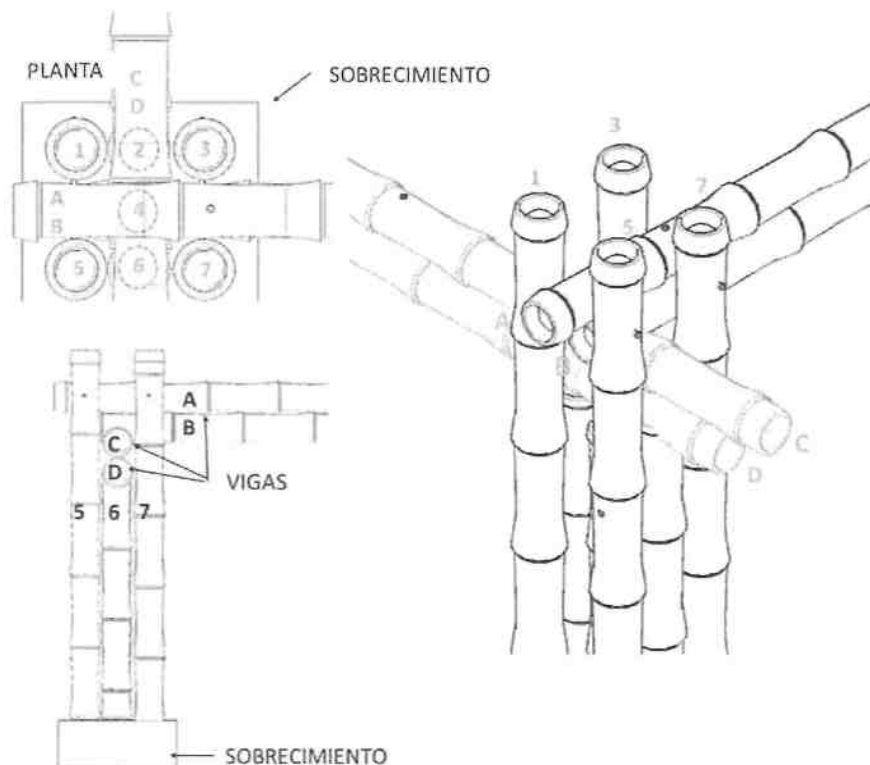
Columna compuesta por 5 culmos y que soportan vigas dobles transversales^A
